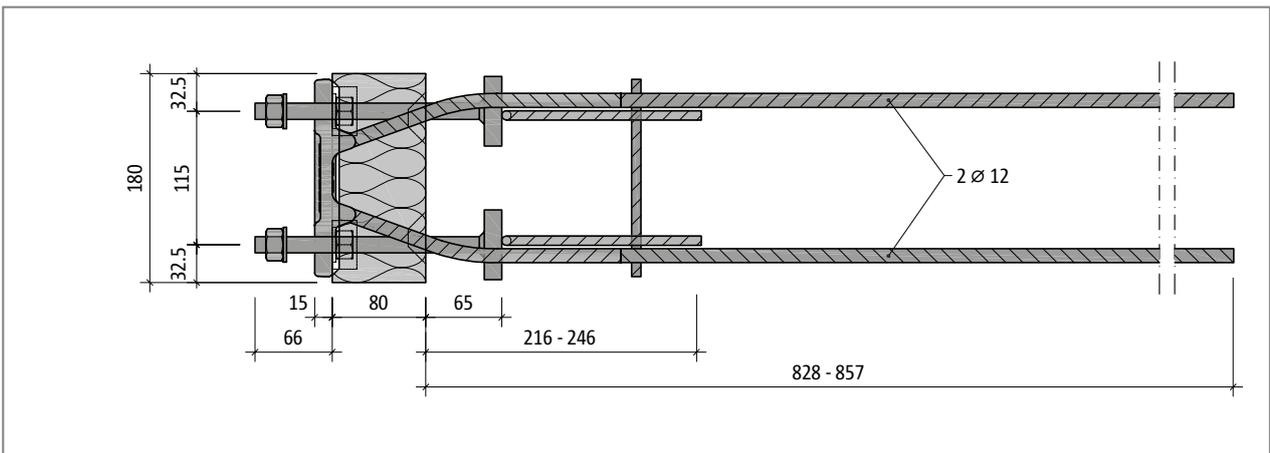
Schöck Isokorb® T type SQ-V3: Plan view
